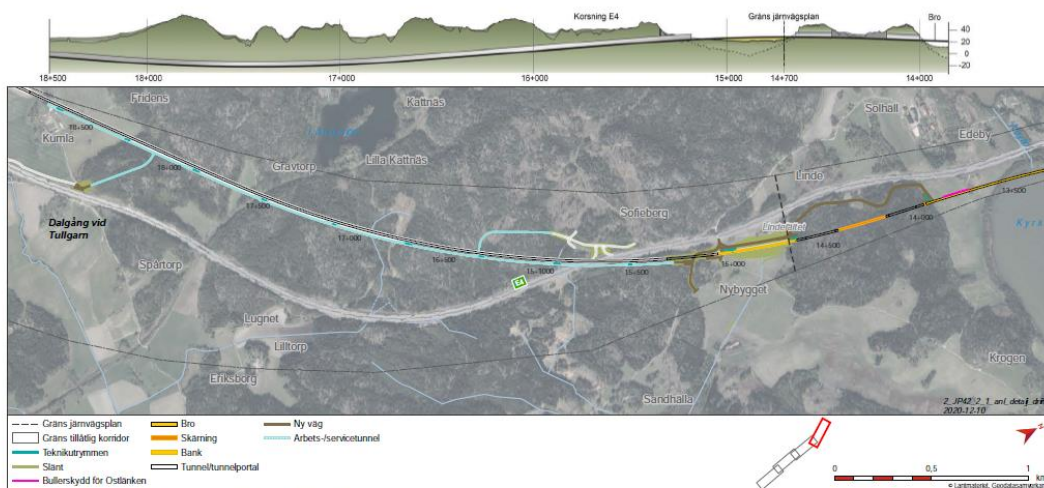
Järnvägsanläggningen vid Hölö, Kyrksjön och Linddefältet. Plan och profil.
